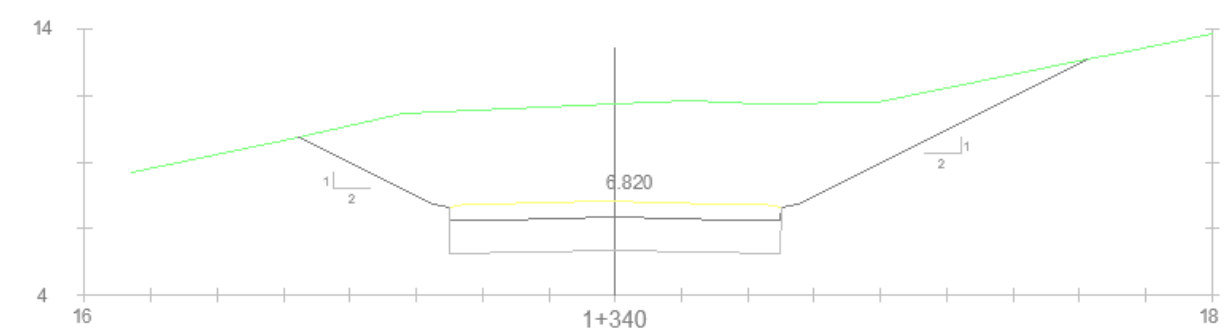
Perfil transversal del vial propuesto en la ladera junto a la AP-8.
